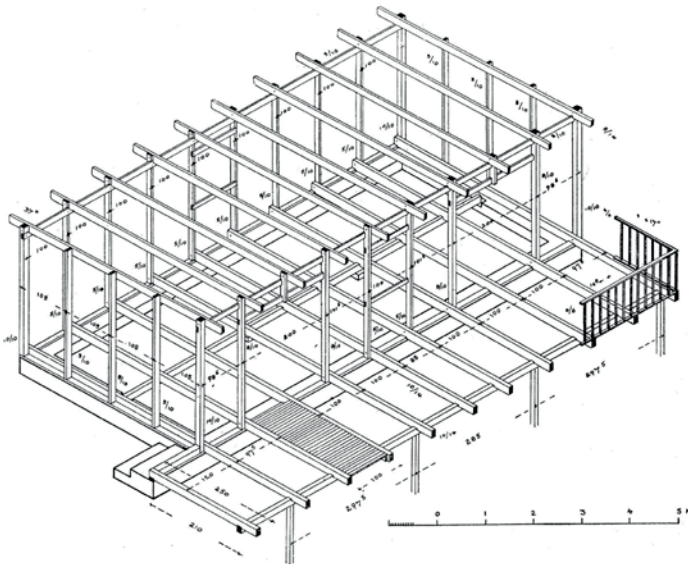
(en haut). Plan structuré sur une grille écossaise, dessiné sur une feuille A4 par Walter Segal (Holland house, 1971)
